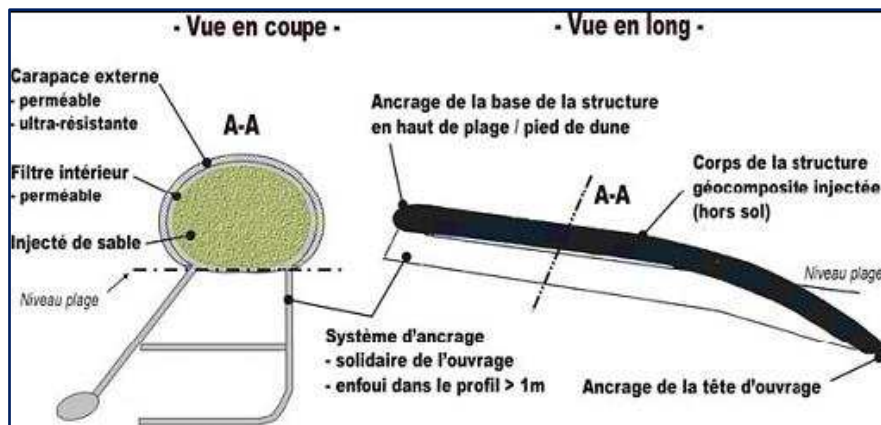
Coupe transversale et longitudinale d'un stabiplage avec ancrage. (www.benoit.guillot1.free.fr, 2013)
